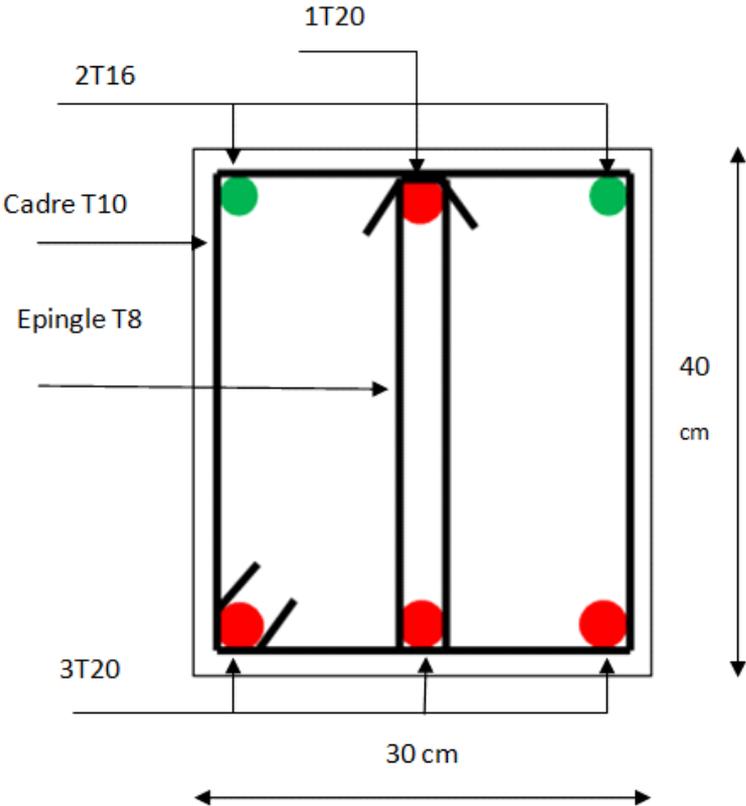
Schéma de ferrailage d'une poutre principale en travée
